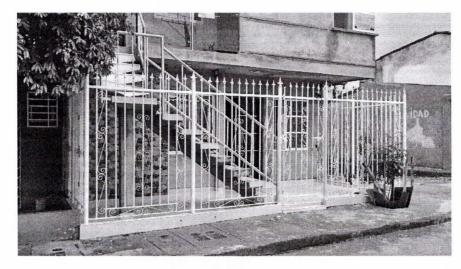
ESCALERA EN EL ÁREA DE ANTEJARDIN, DE LA VIVIENDA UBICADA EN LA MANZANA E, LOTE 13
